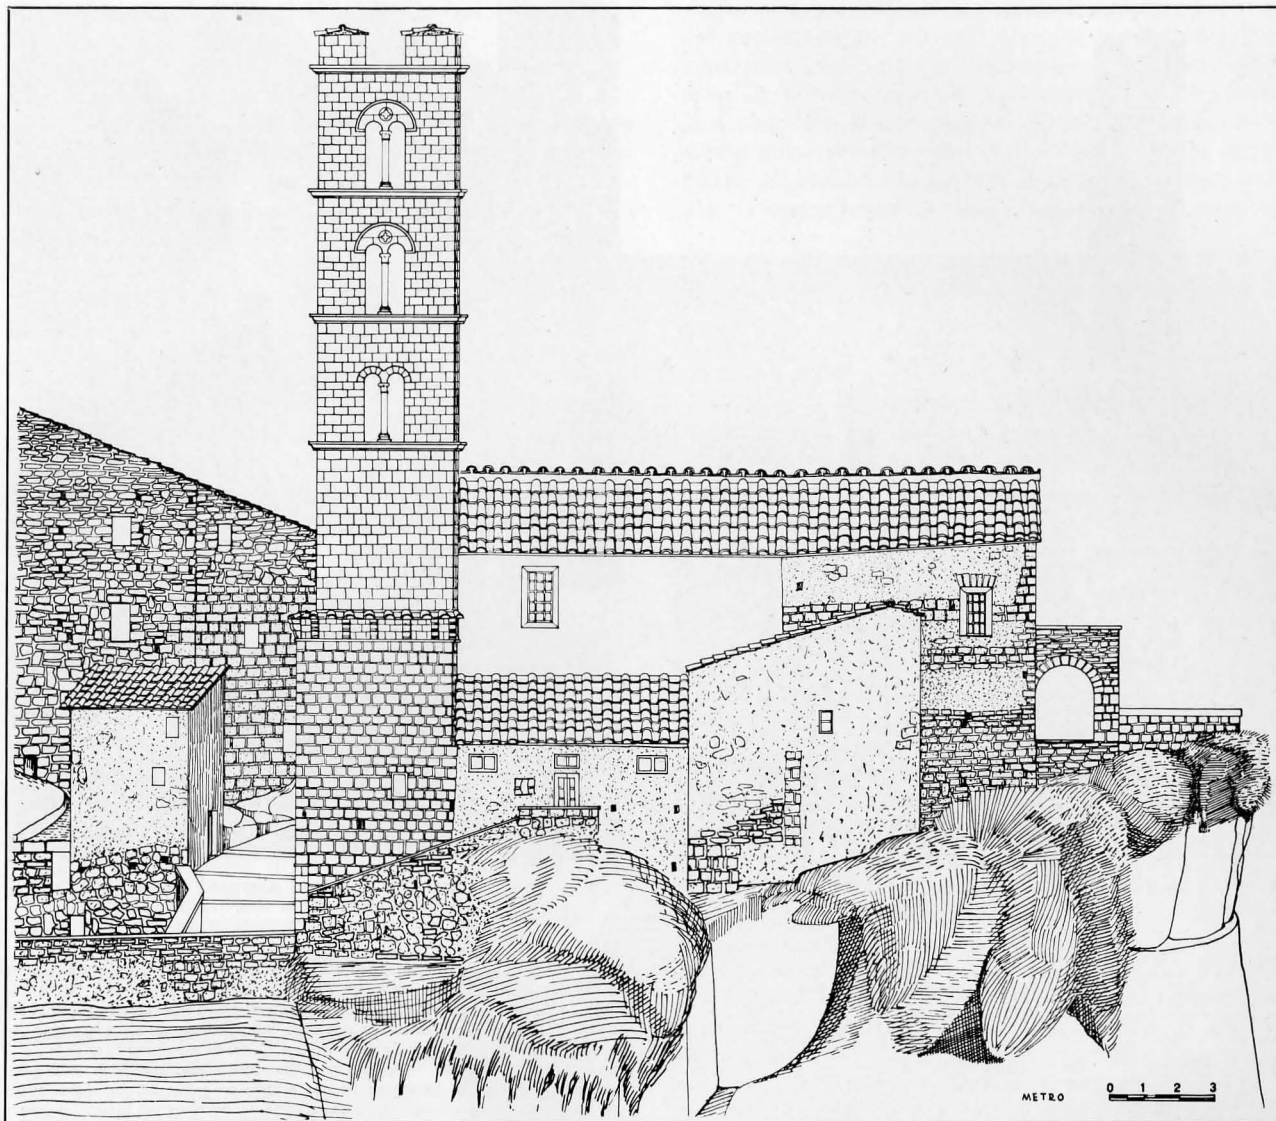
PROSPETTO DELLA PARETE SINISTRA: PROGETTO DI RESTAURO (Dis. C. Berardi)
